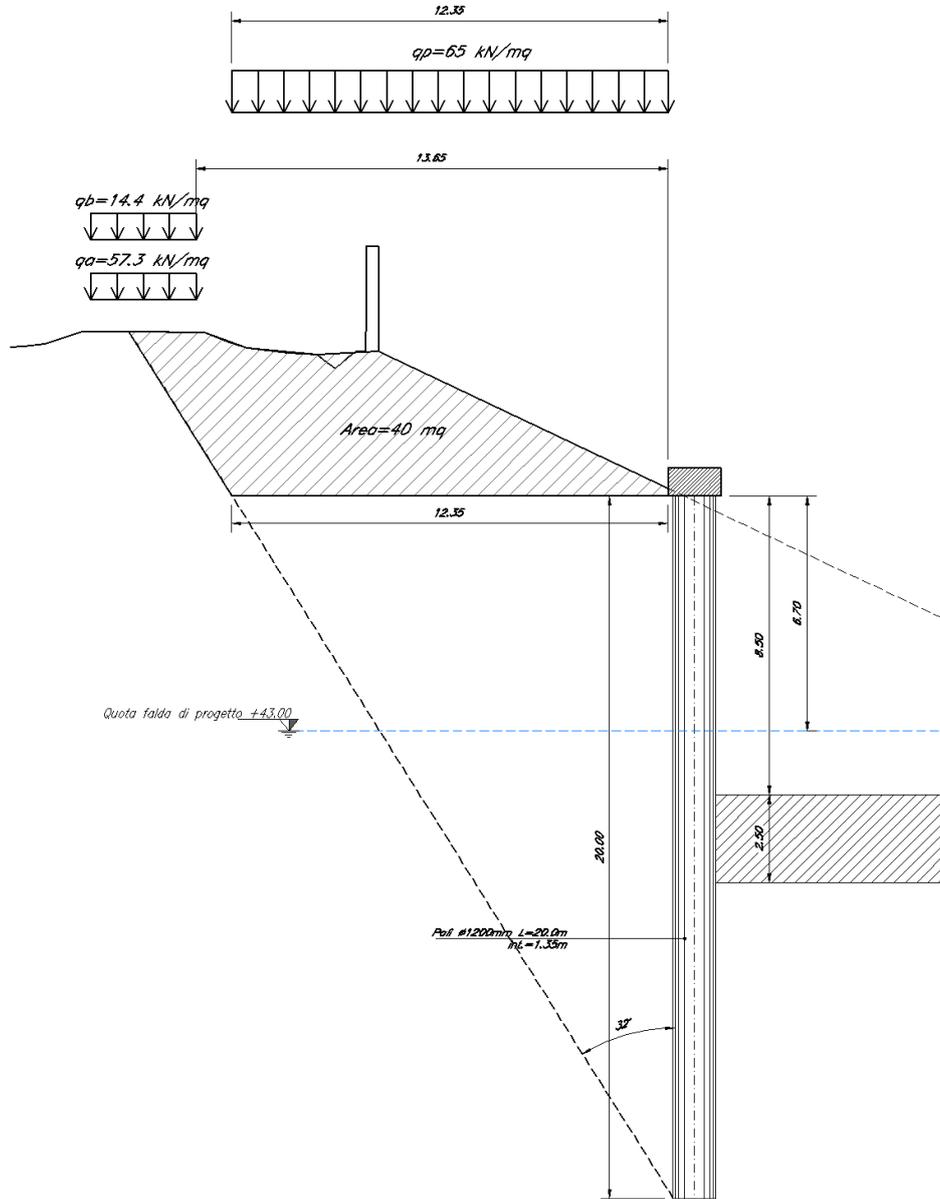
Pila 3 - sez.2: modello di calcolo
